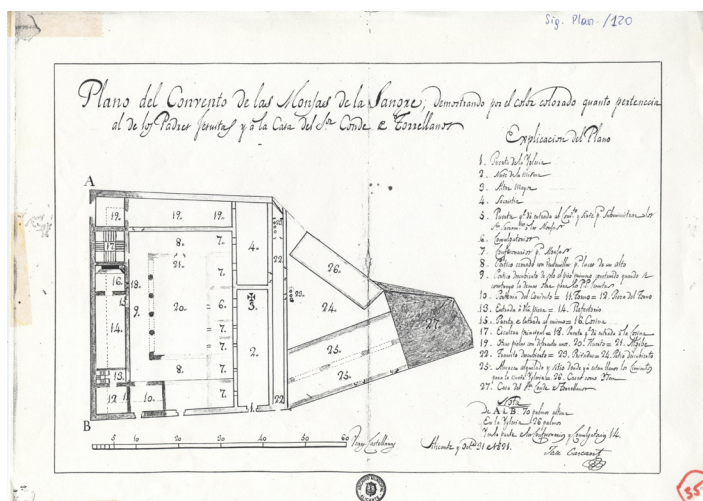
Planta del convento de Jesuitas de Alicante. Autor: M. Bevià.
